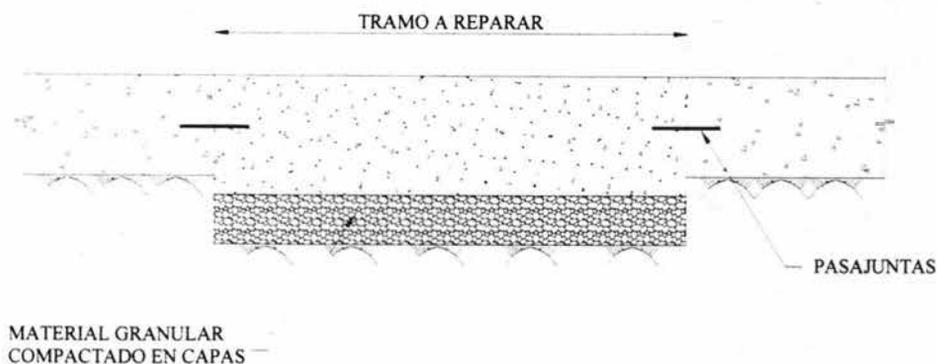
Reposición de losa de concreto por falla del terreno de apoyo
